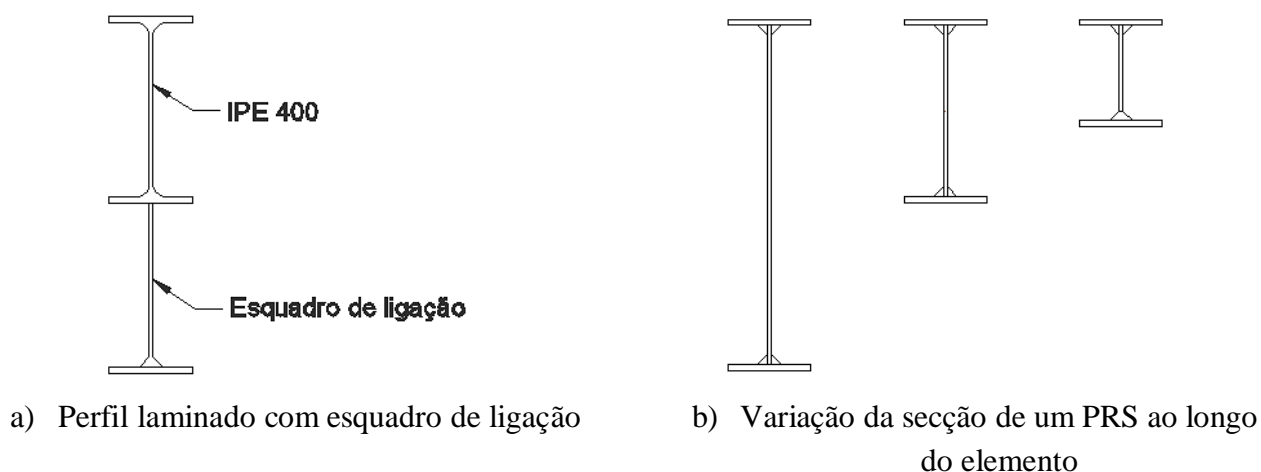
Perfil laminado e perfil reconstituído por soldadura (PRS)
